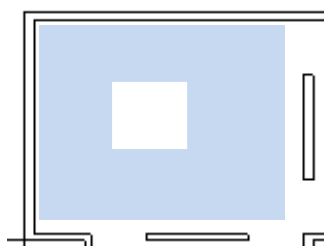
Módulo Contexto Urbano. Planta baixa com localização da maquete física.
